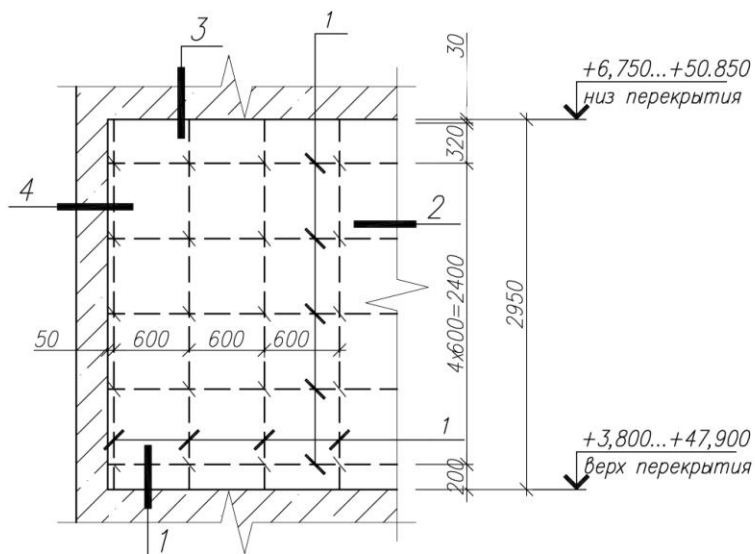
Схема узла перегородок типового этажа из керамзитобетонных блоков толщиной 100мм
